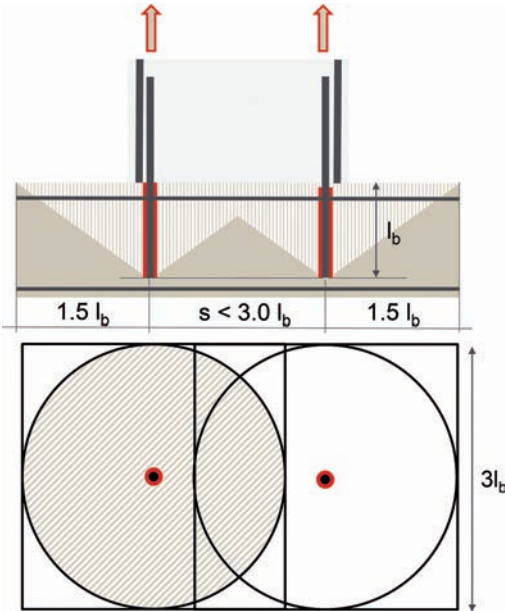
Einfluss des Achsabstands auf die Form des Betonausbruchkörpers bei zugbeanspruchten Zweiergruppen von Bewehrungsstäben
